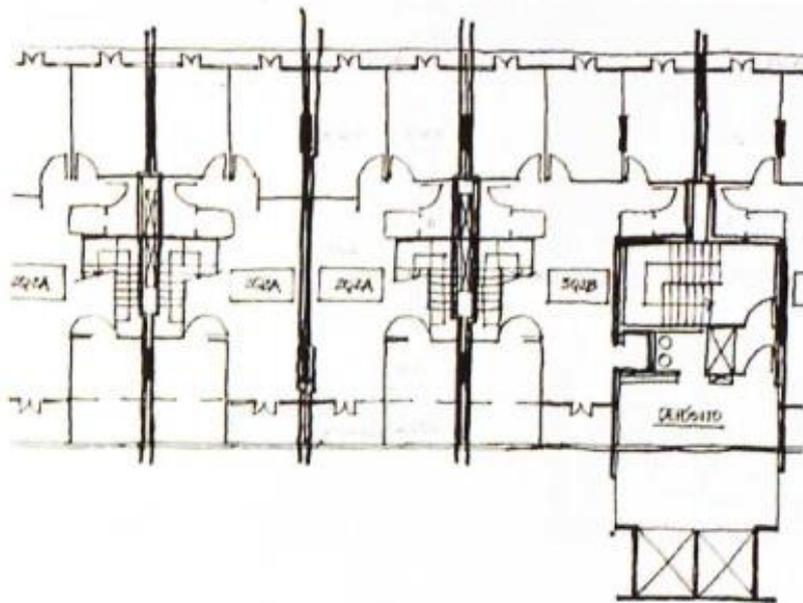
Desenho da planta baixa do nível acima e abaixo do deque.
